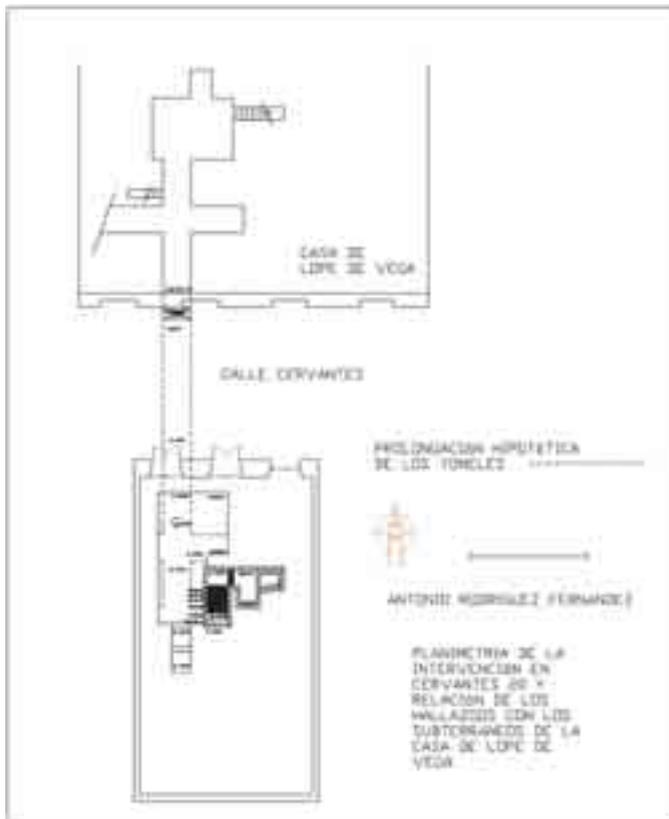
Planimetría de la intervención y prolongación hipotética de los túneles de ambas construcciones.
